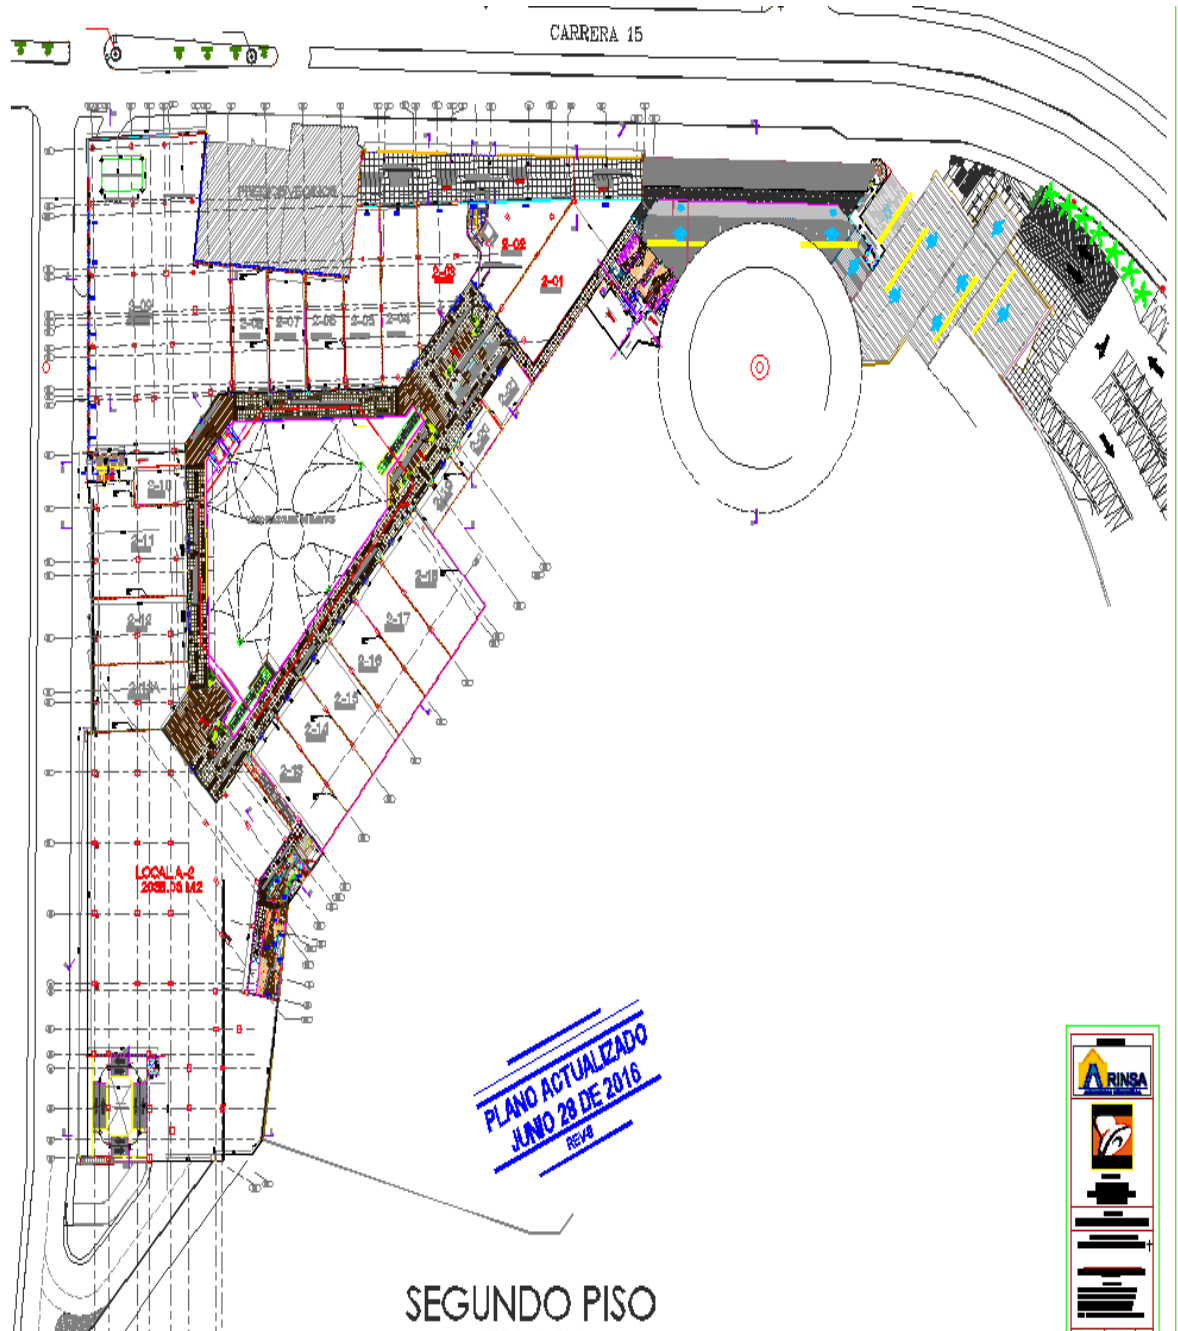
Planta arquitectónica de segundo piso (Fuente: Diseños arquitectónicos ARINSA)
